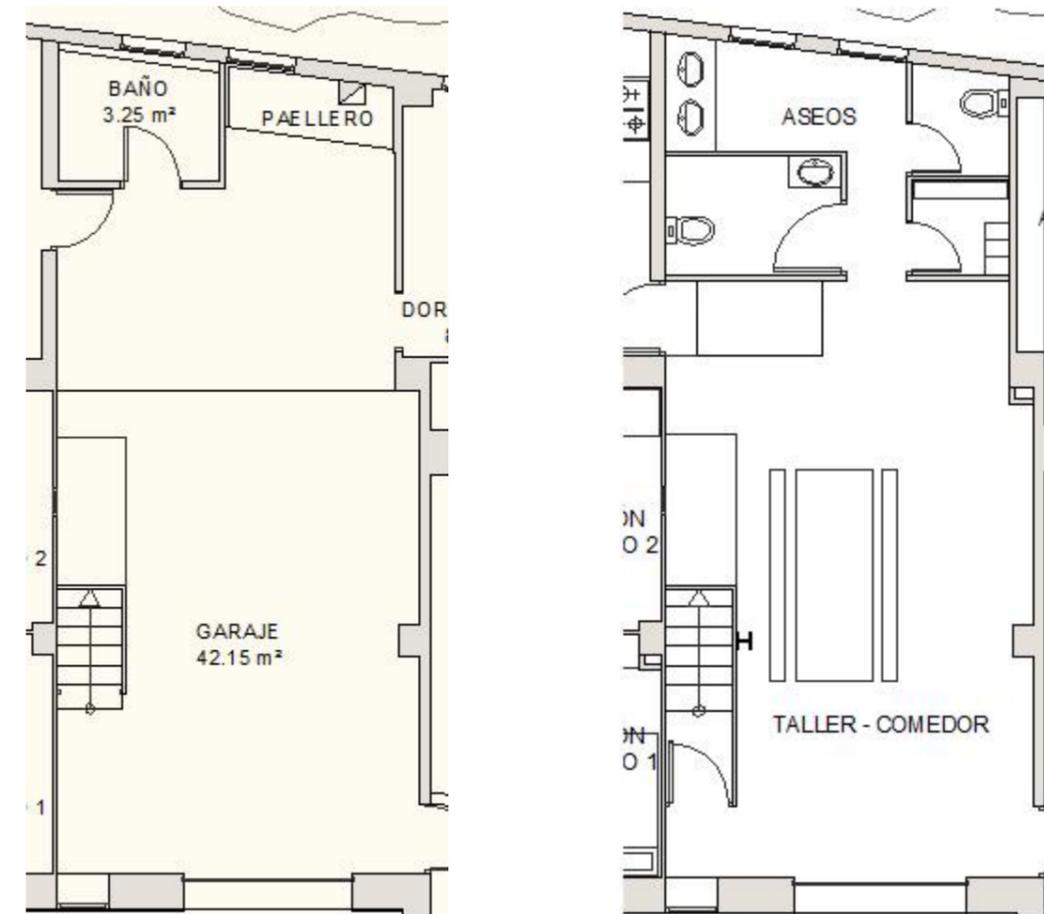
Estado actual (Imagen izquierda), Estado propuesto (imagen derecha). Año 2014. Fuente: propia autora
